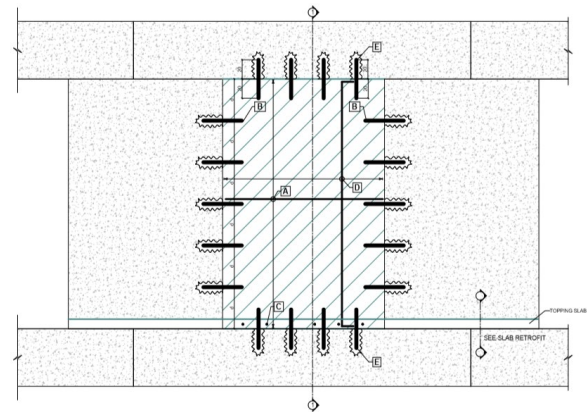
Unión piezas prefabricadas con hormigón armado y conexión con pasadores.
